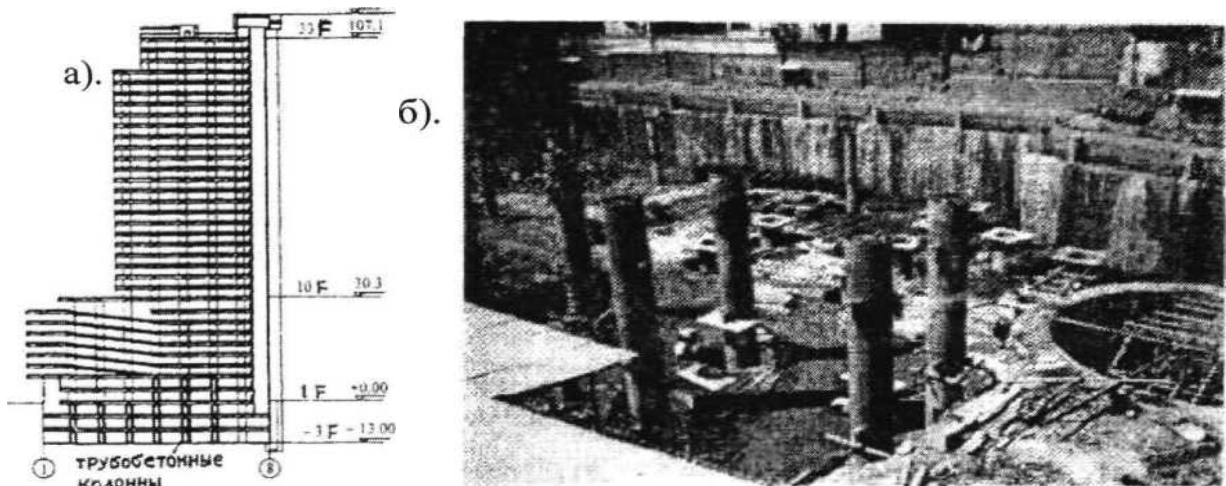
Будівля «Peace World Plaza» м Гуанчжоу а - розріз; б - процес зведення підземної частини з застосуванням трубобетонних колон
